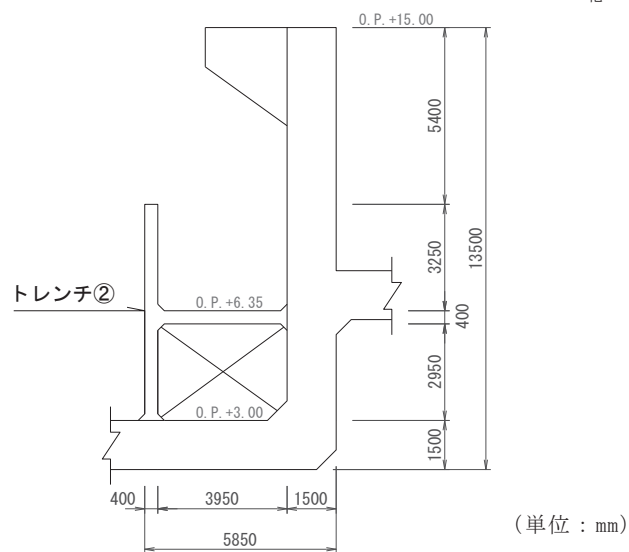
(8) 補機ポンプエリア断面図 (⑧—⑧断面)
